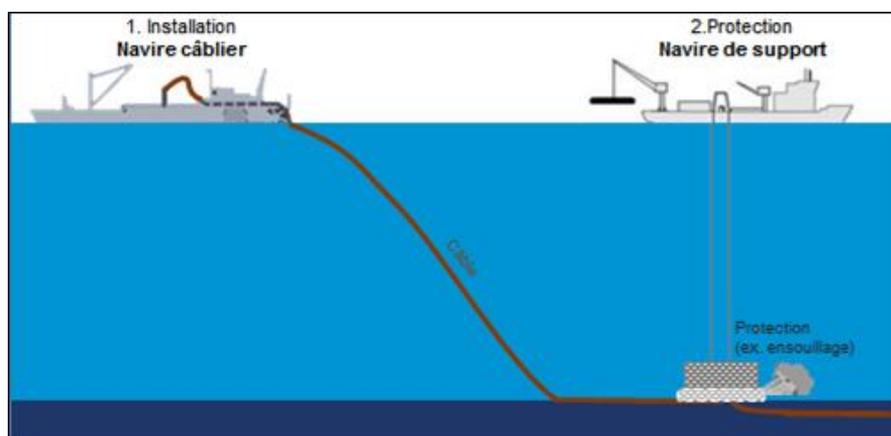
Illustration de l'installation et de la protection des câbles (Source : RTE, 2016)
